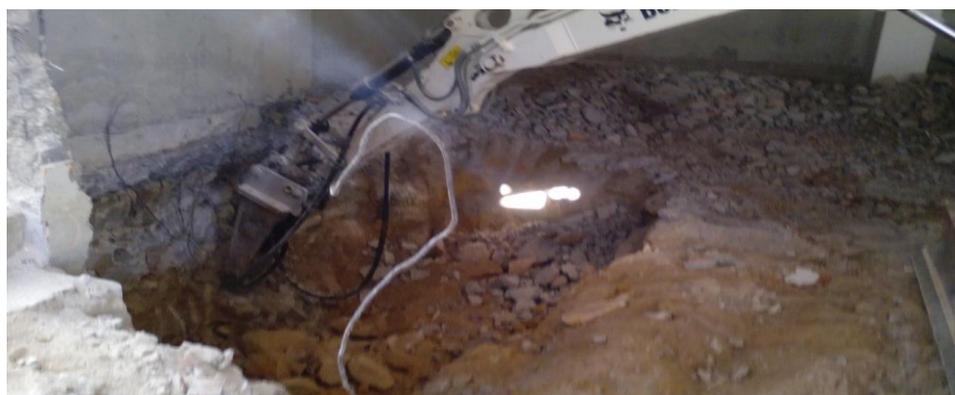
Escavação para sapatas Edifício Frente Existente (foto do autor)
